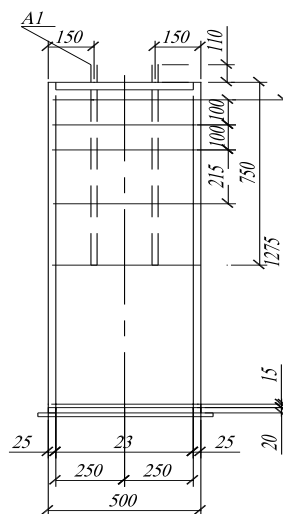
Монолітний фундамент ФМ 5 по осі 1
